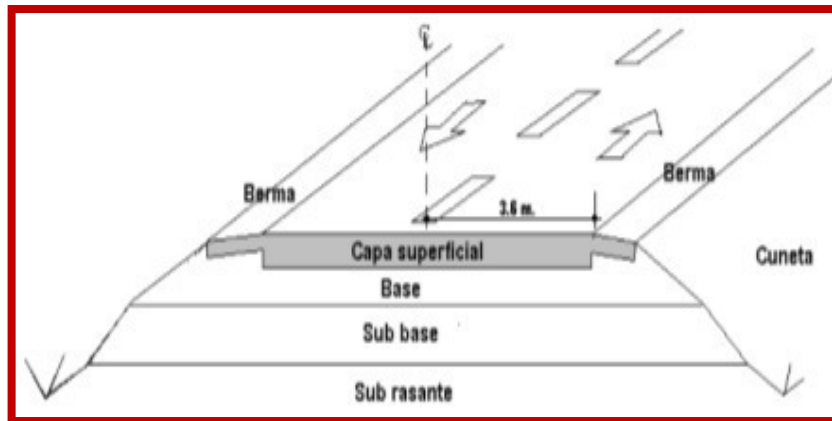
Estructura típica de un pavimento asfáltico (flexible)
